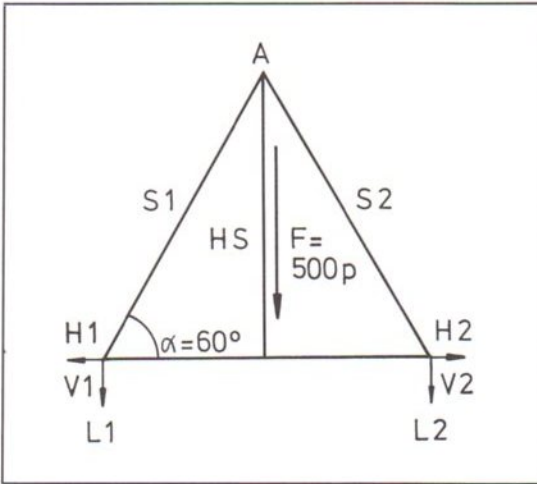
Lageplan eines Hängewerks mit einer Streben-Neigung von 60 Grad zur Horizontalen.
